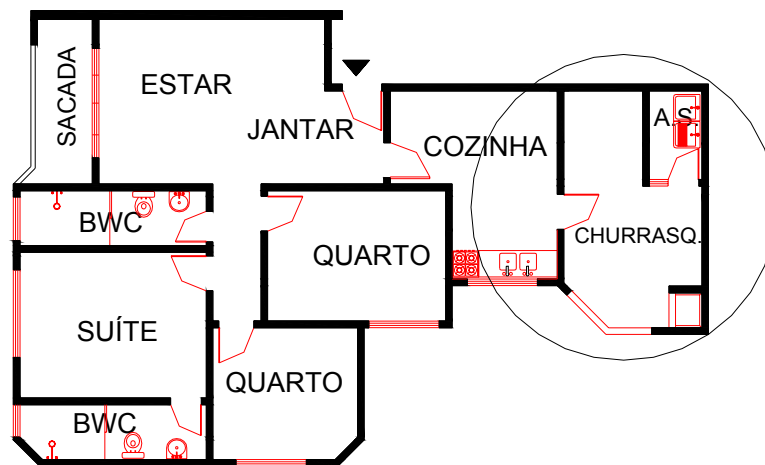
Planta Baixa do apartamento 702 – Estudo de caso B.
